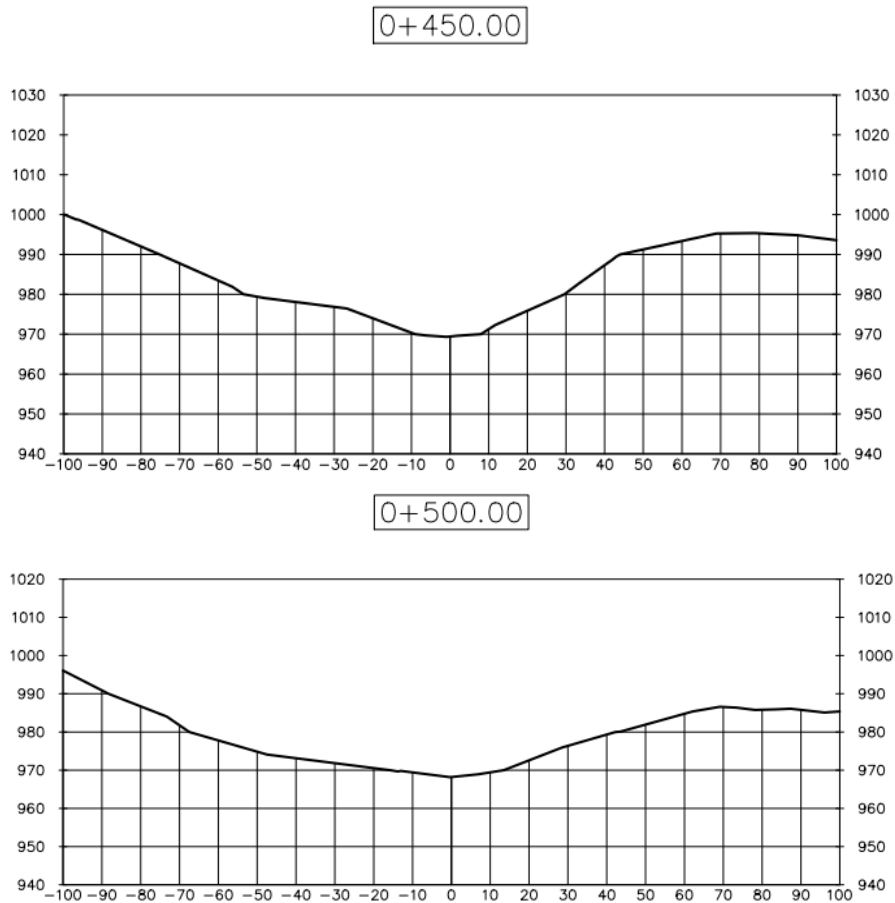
Creación Propia “Algunas de las secciones obtenidas del levantamiento topográfico.
